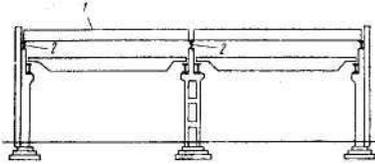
Одноэтажные промышленные здания с плоским покрытием
